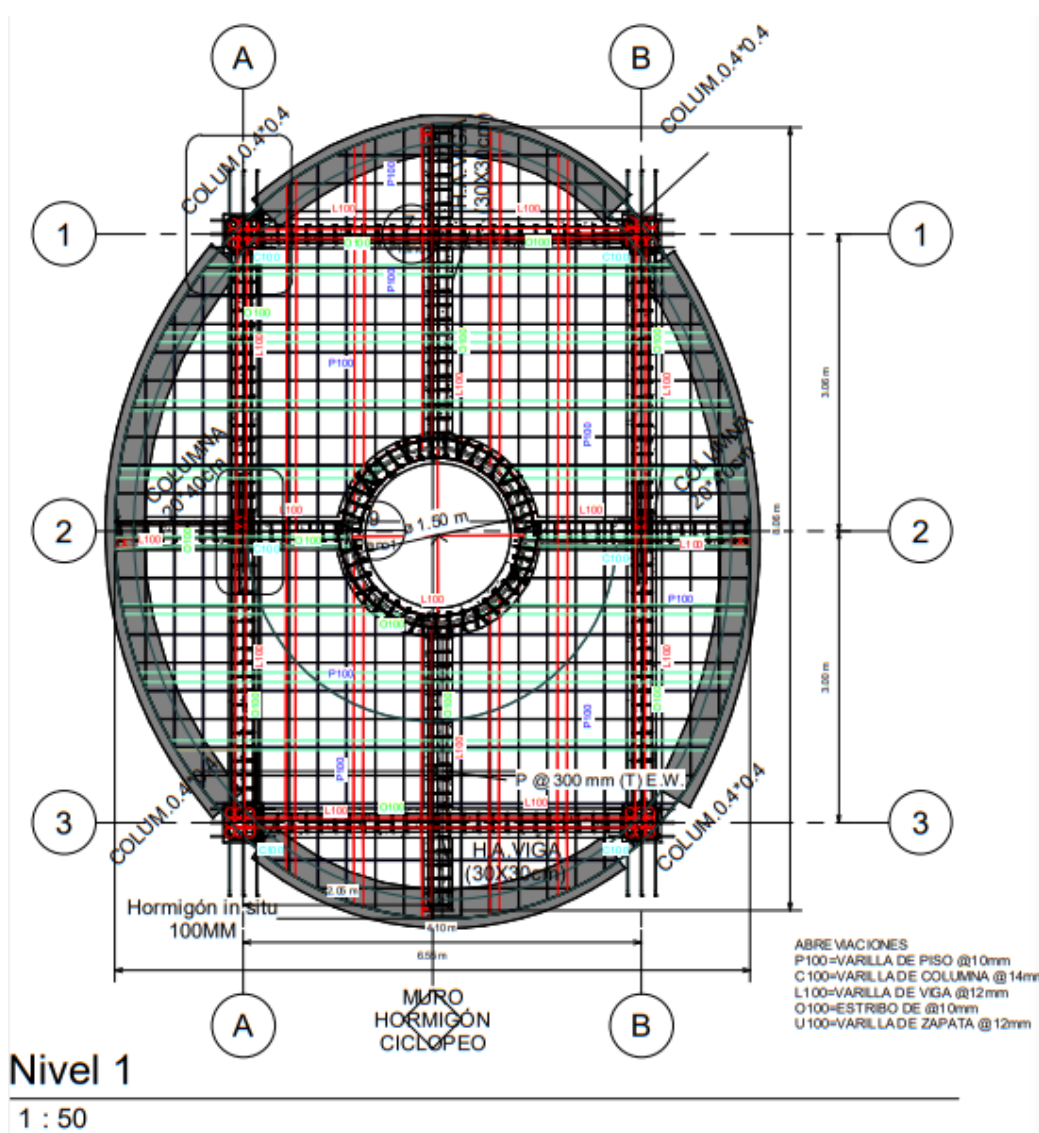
Vista en planta de armadura de zapatas y muro de hormigón ciclópeo.
